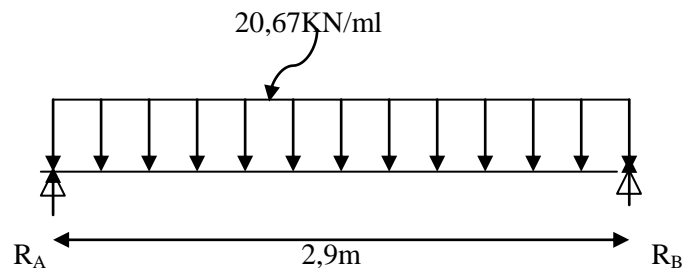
Schéma statique de la poutre palière ELS
